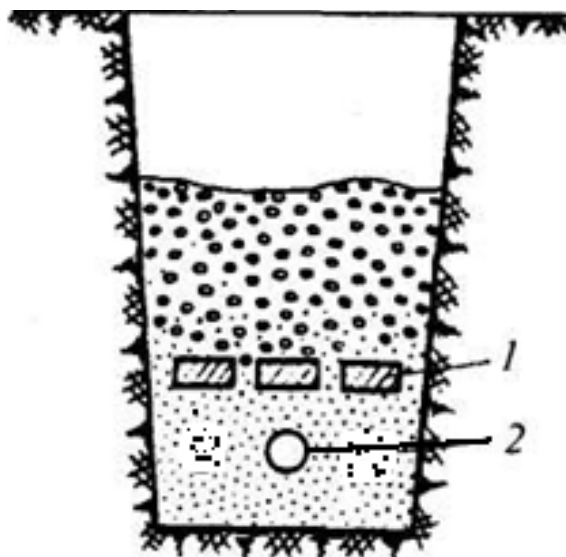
Поперечный разрез кабельной траншеи: 1 – красный кирпич для защиты кабеля; 2 – силовой кабель
